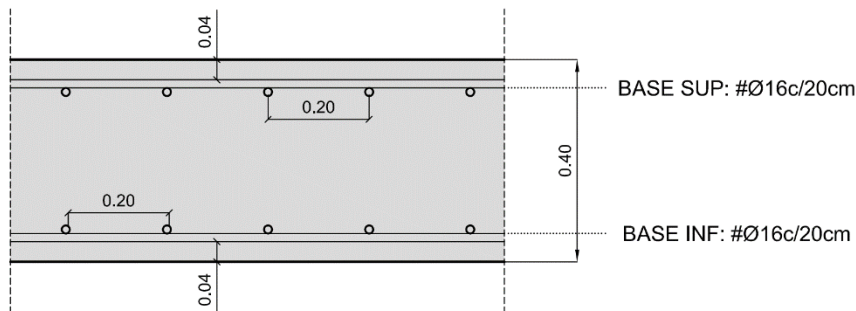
Sección de losa maciza de 40 cm de canto. Fuente: David Gallardo.
